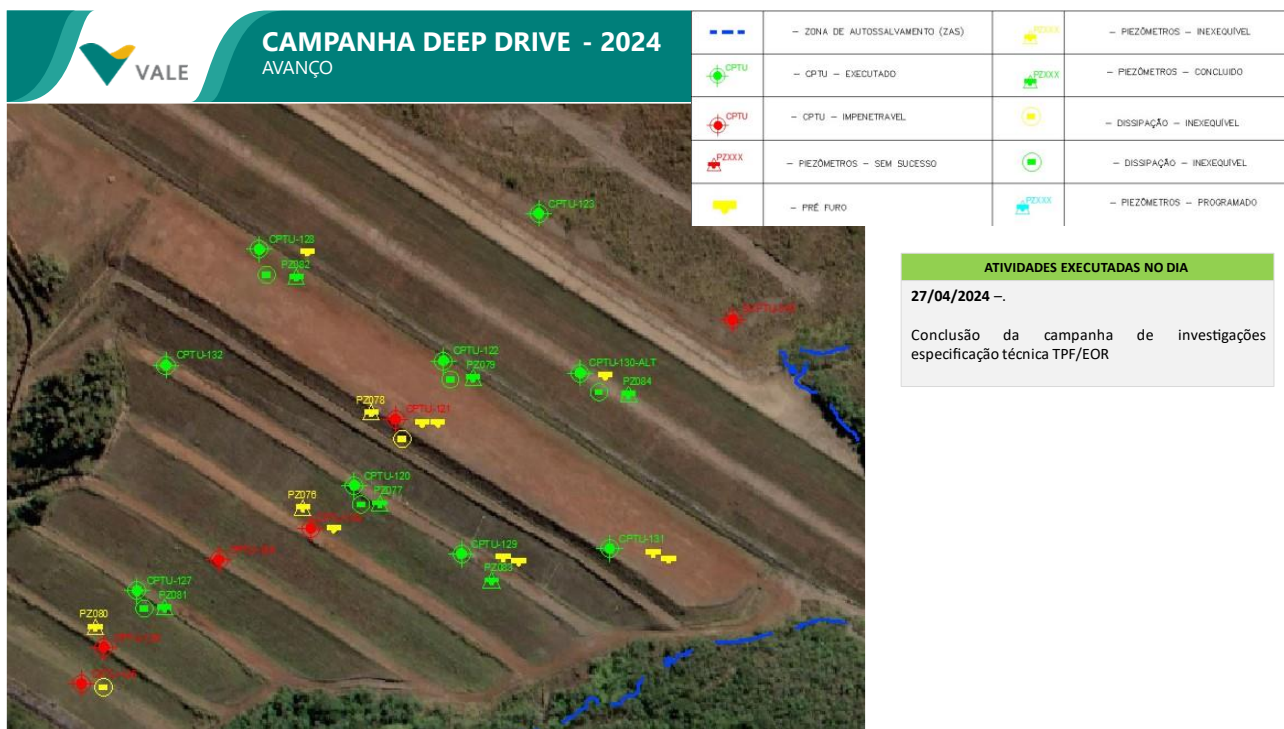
Campanha de investigações – Deep Drive - Escopo (março/2024).
